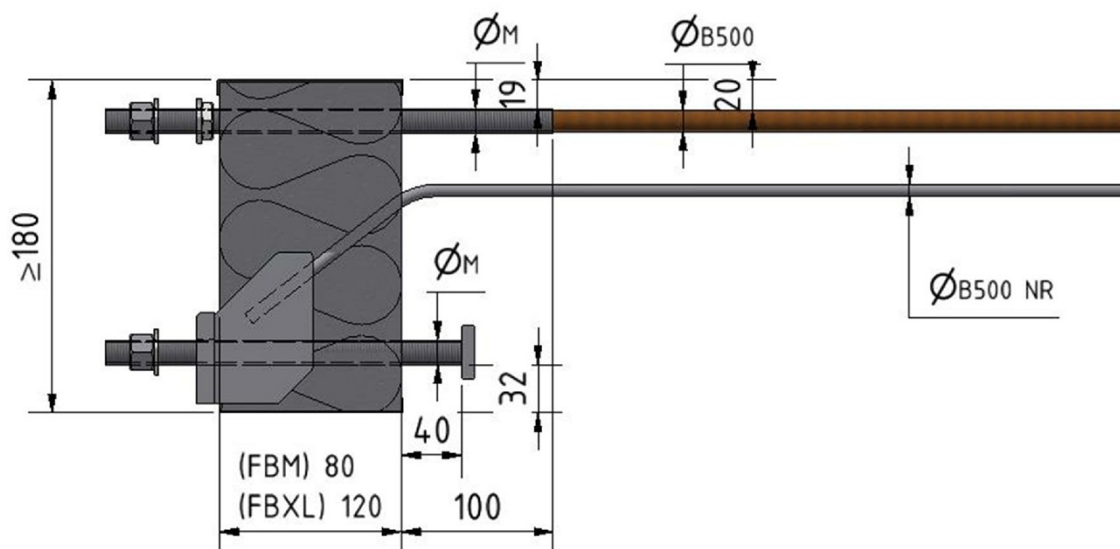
Max Frank Egccobox® FBM/XL-CB mit Drucklager
